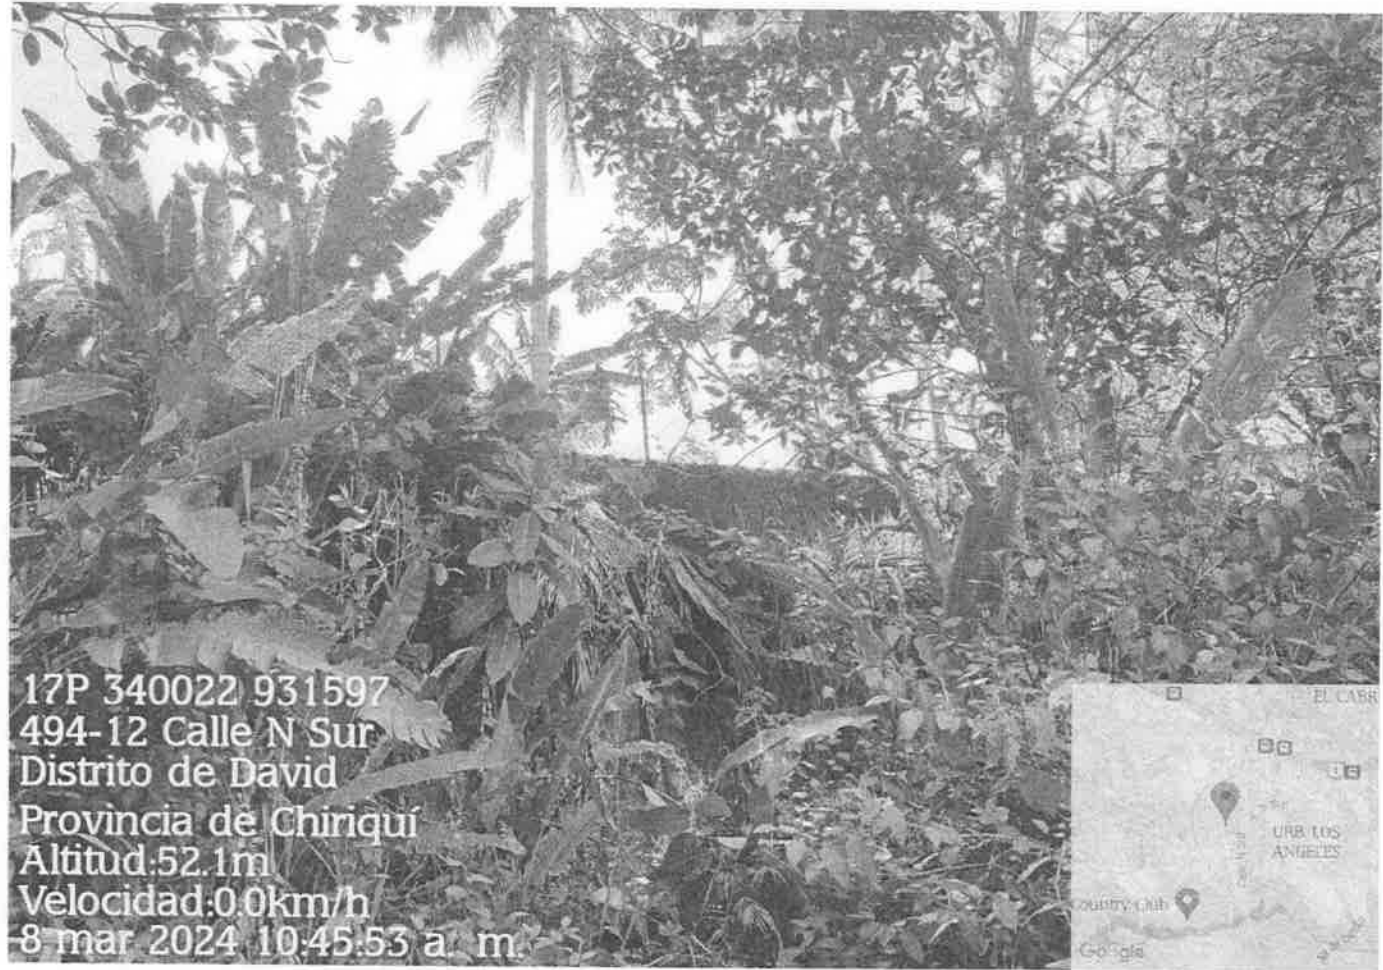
Área de posible derrumbe e inestabilidad de taludes de la urbanización Guillermo de Roux colindantes con los lotes del proyecto a intervenir.
